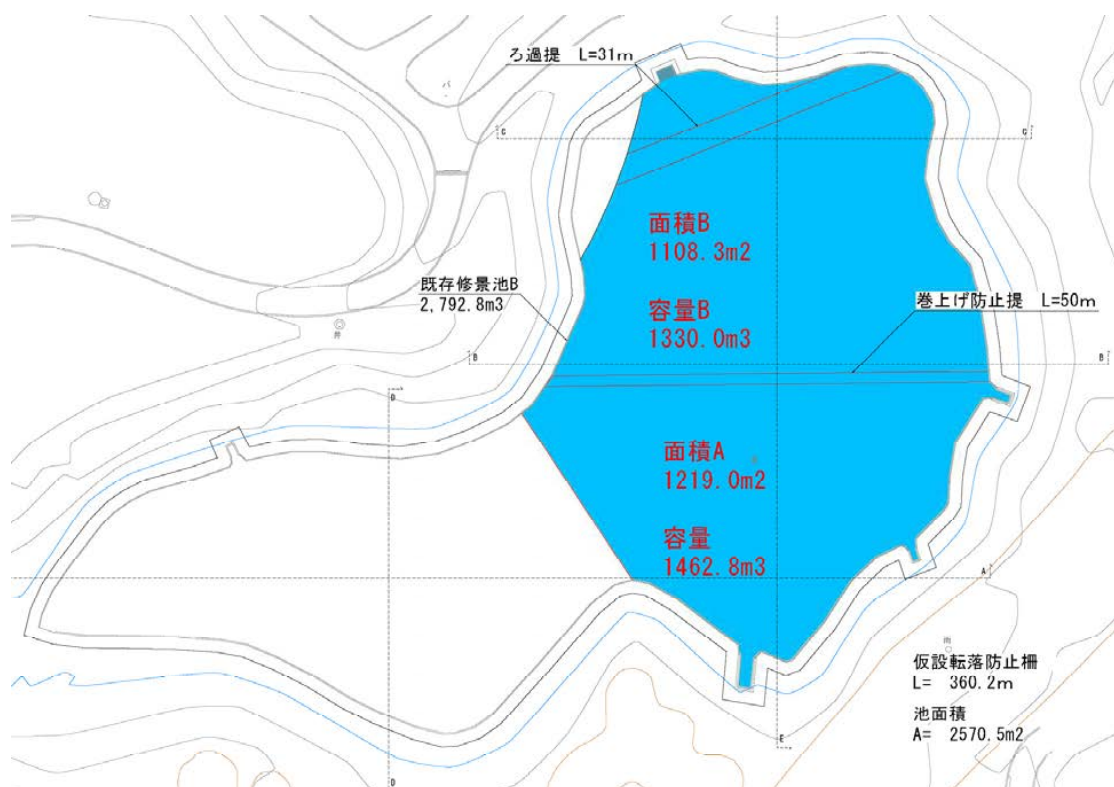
1号濁水処理施設平面図（既存修景池を利用）
